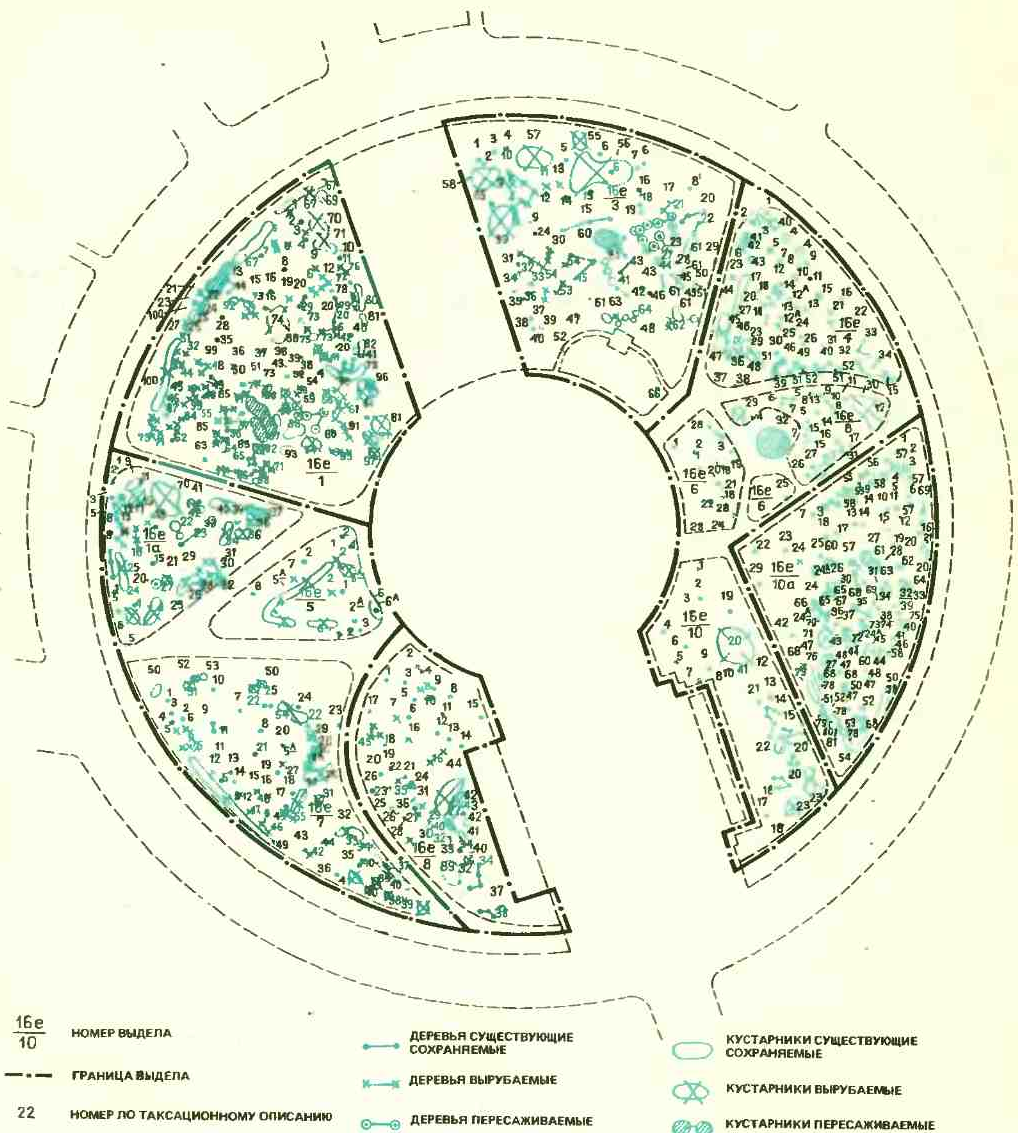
Участок зоны тихого отдыха в парке. План таксации, вырубki и пересадки зеленых насаждений
